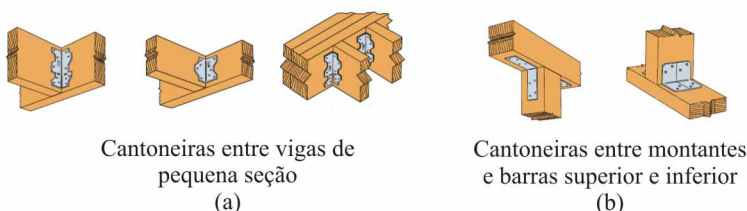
Exemplos de aplicação de cantoneiras simples em peças do sistema leve em madeira (adaptado de STRONGTIE, 2008).
